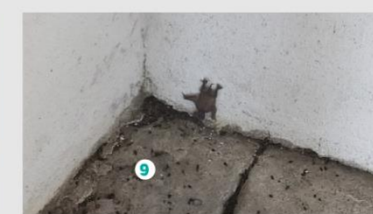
Manchas de guano en enrase de muro (sección 2). El espacio entre muro y viga es utilizado como refugio por murciélagos.
